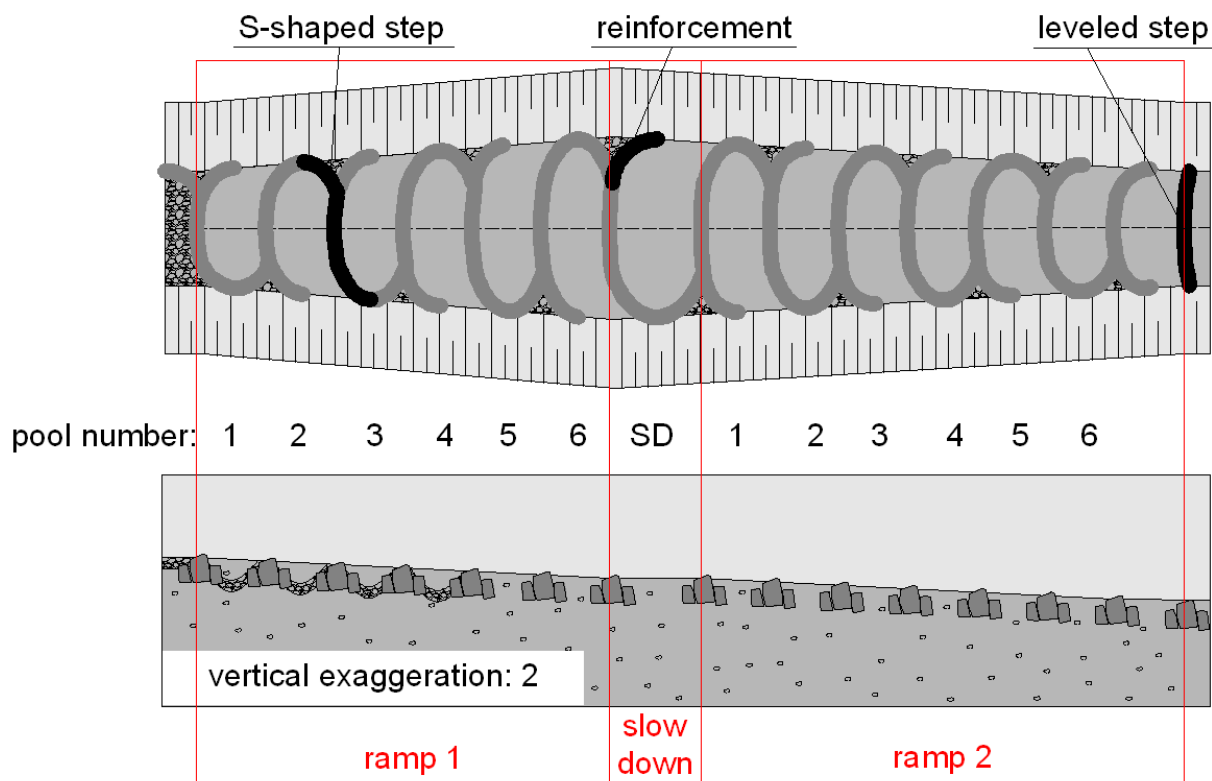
Pendelrampe, Grundriss (oben), Längenschnitt in Flussachse (unten), Querprofil siehe Abbildung 9.2
